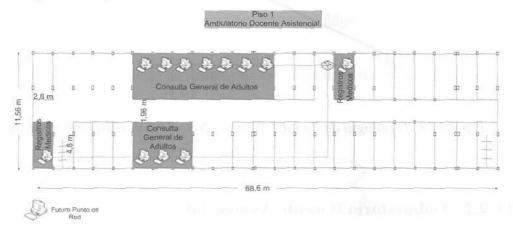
Levantamiento Planimétrico del piso 1. (Elaboración Propia)
